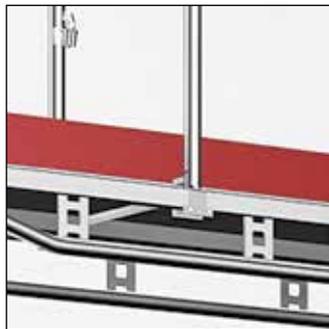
Detalle de la viga puente en U de aluminio con espigas
